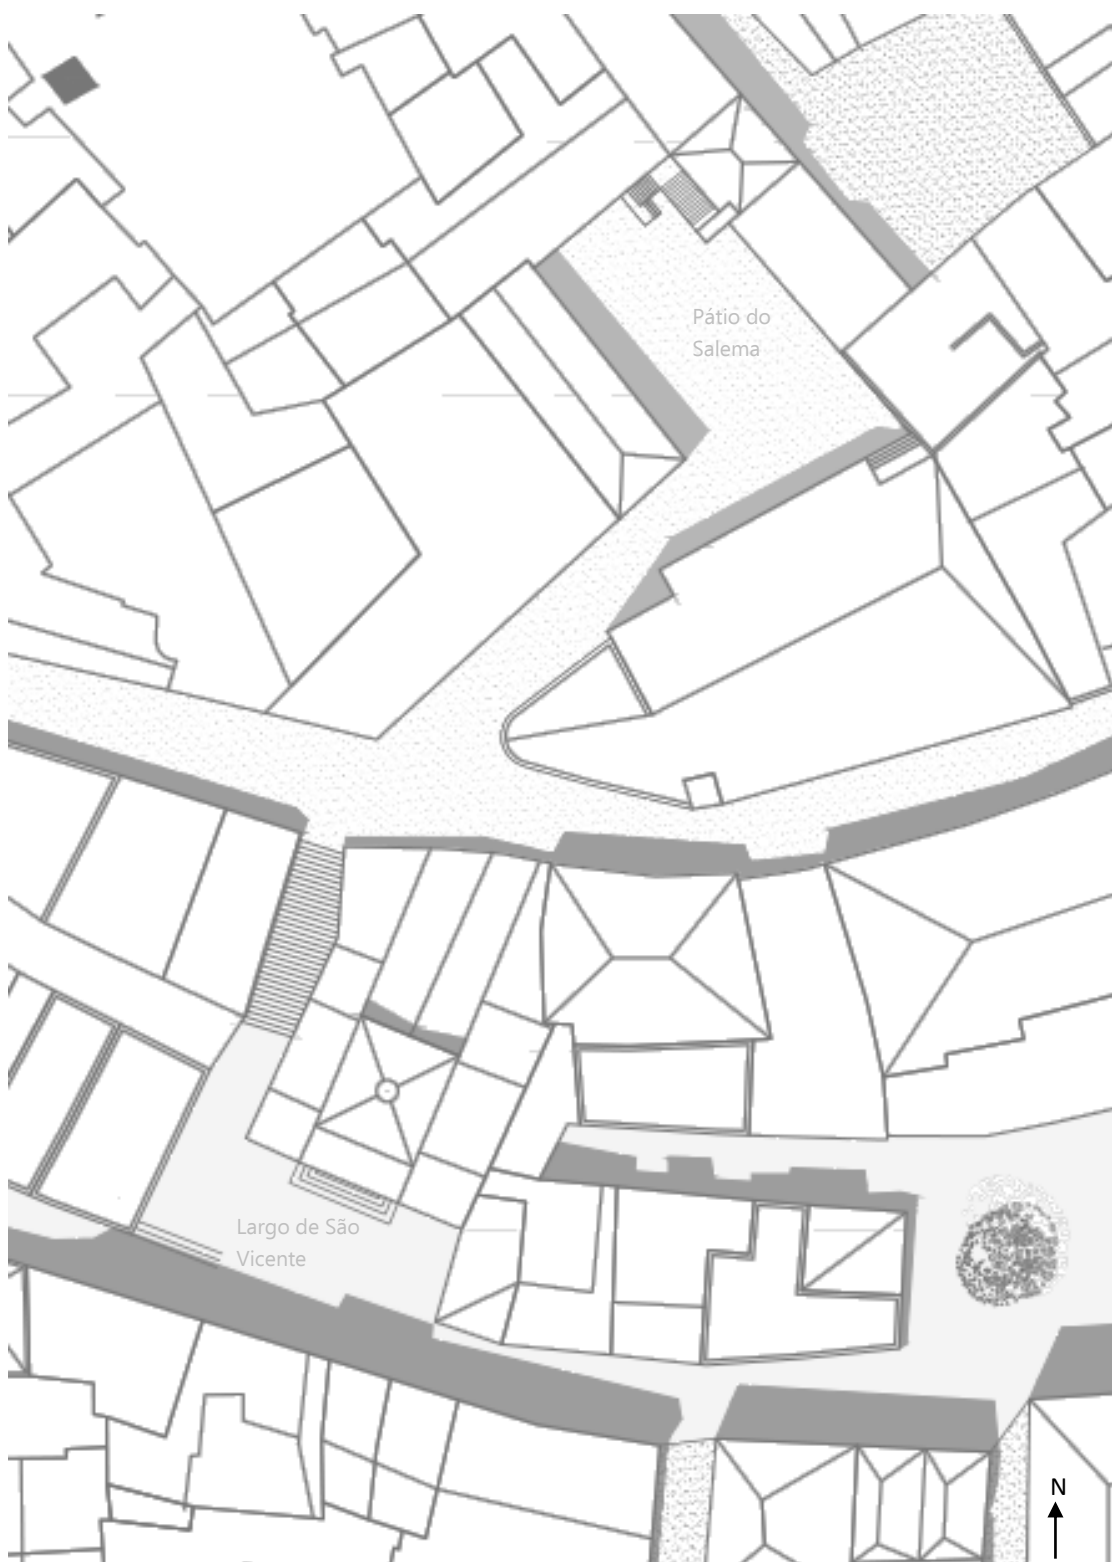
Planta conjunto – Largo de São Vicente e Pátio do Salema
